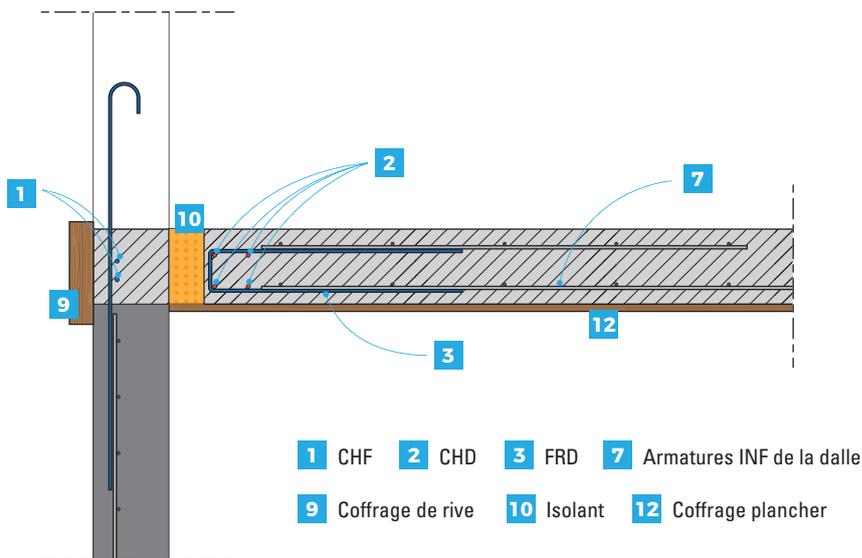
Solution 1 – Voile arasé en sous-face de dalle :
